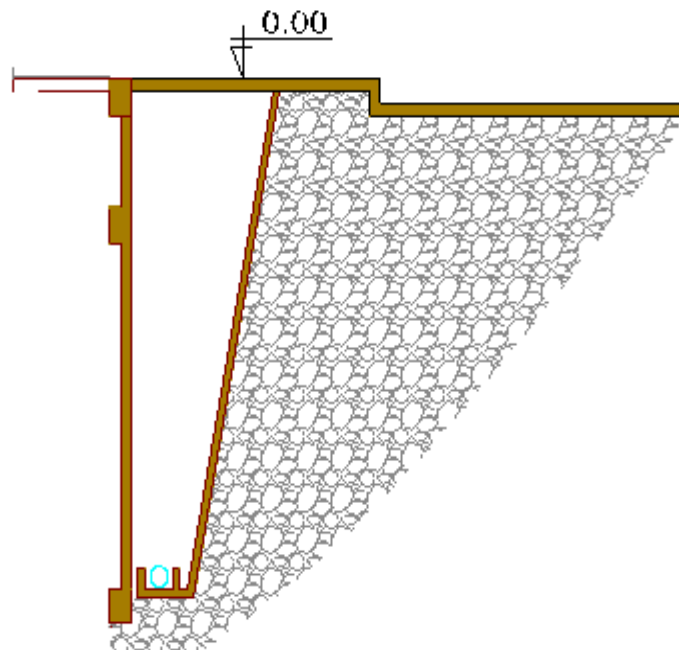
Schéma statique du mur plaque (vue en élévation).
